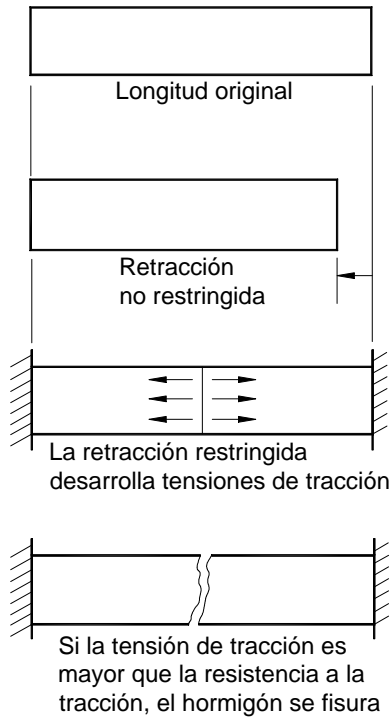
Fisuración del hormigón provocada por la retracción por secado
